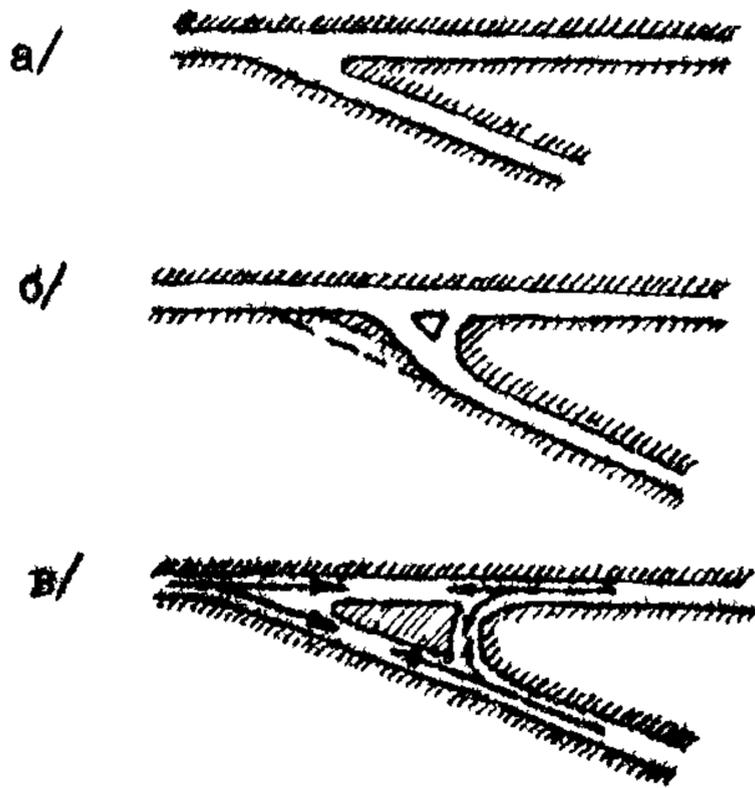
Способы реконструкции примыканий и разветвлений дорог под острым углом: а - неправильное примыкание под очень острым углом; б - улучшение условий движения путем смещения места примыкания в - устройство дополнительной полосы.
